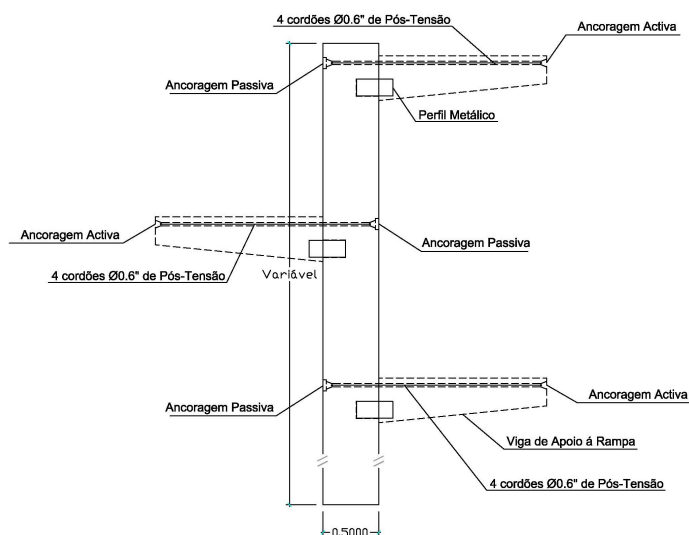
Pilar tipo da estrutura de acesso com respectivas vigas de apoio à rampa [18]
